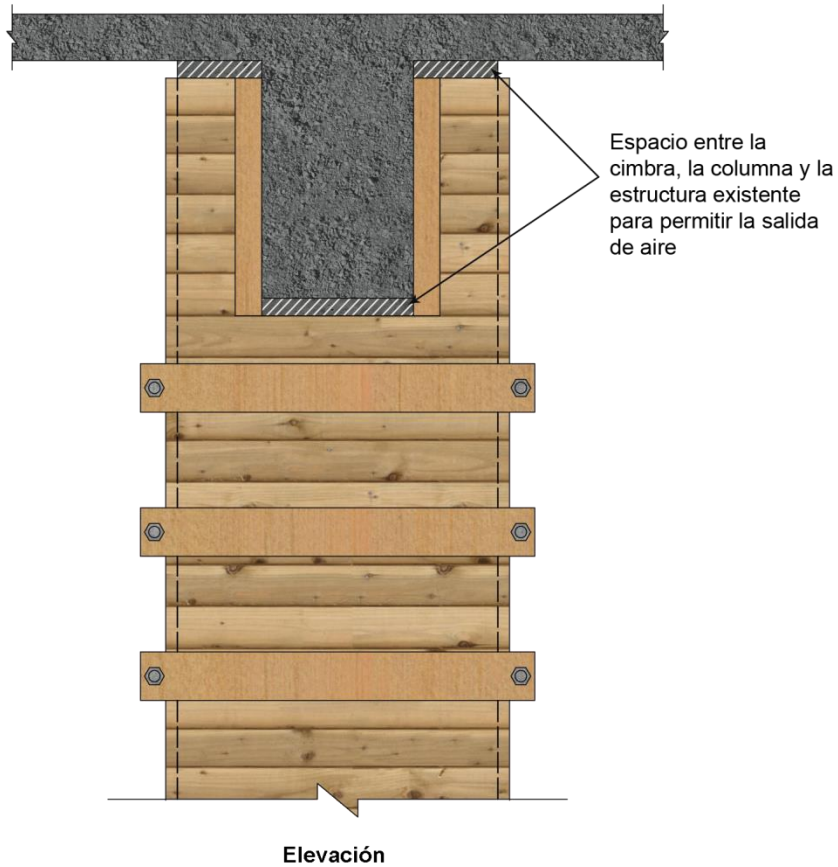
Ejemplo de cimbra de columna encamisada diseñada para facilitar la salida de aire del concreto.
